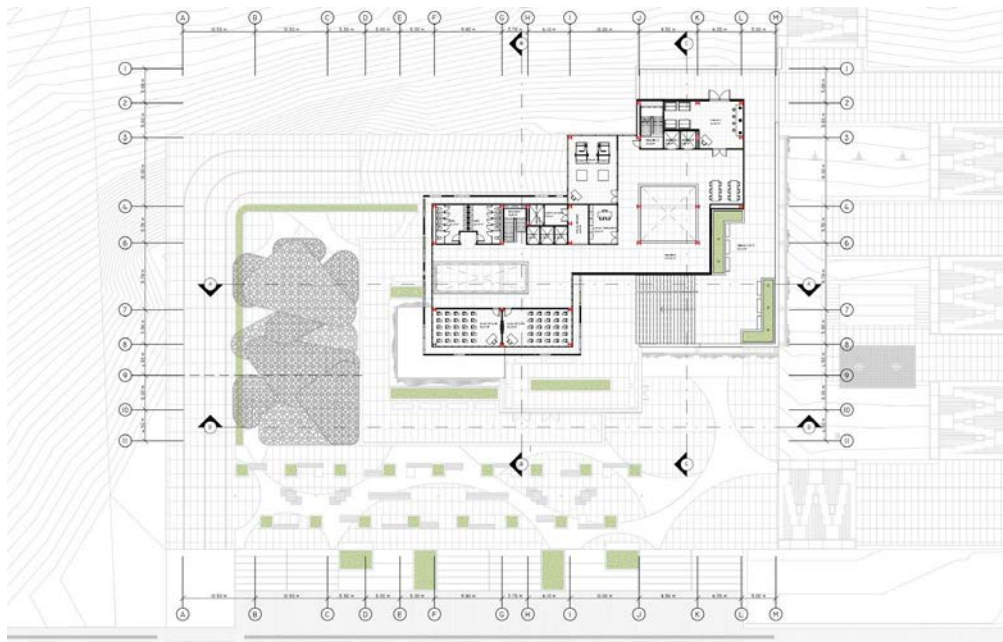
Planta Quinto piso. Fuente: Propia.
